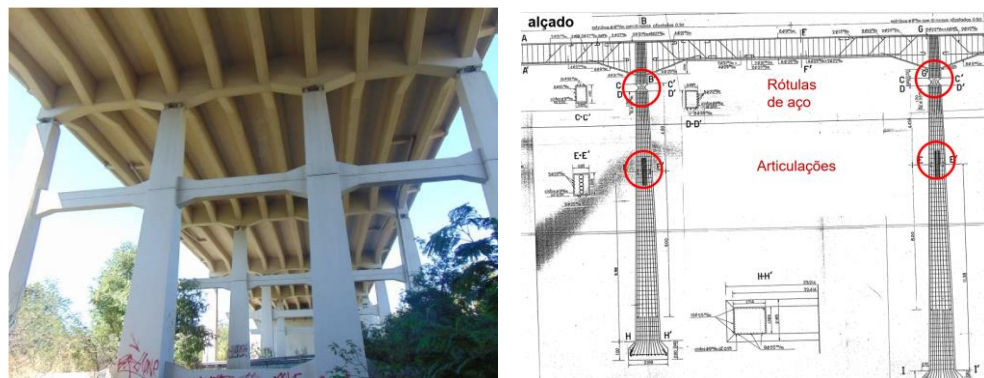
Vista dos pilares do viaduto com articulações ao nível da travessa marcadas por uma junta e extrato do desenho de projeto mostrando as articulações em causa.
